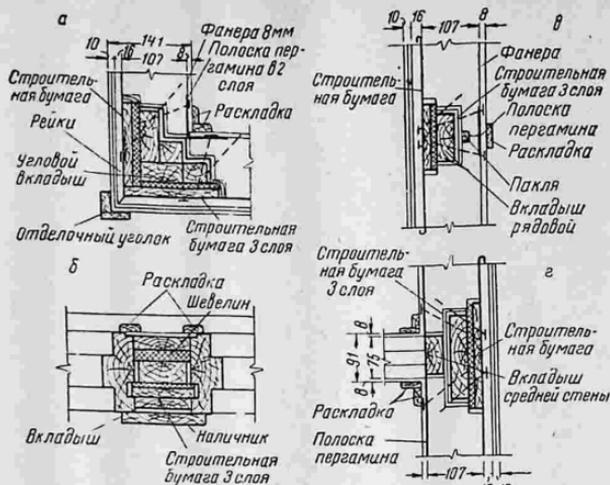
Стыки щитов наружных стен сборного дома: а—угловых; б—с окнами; в—глухих; г—двух глухих со щитом внутренней стены.
